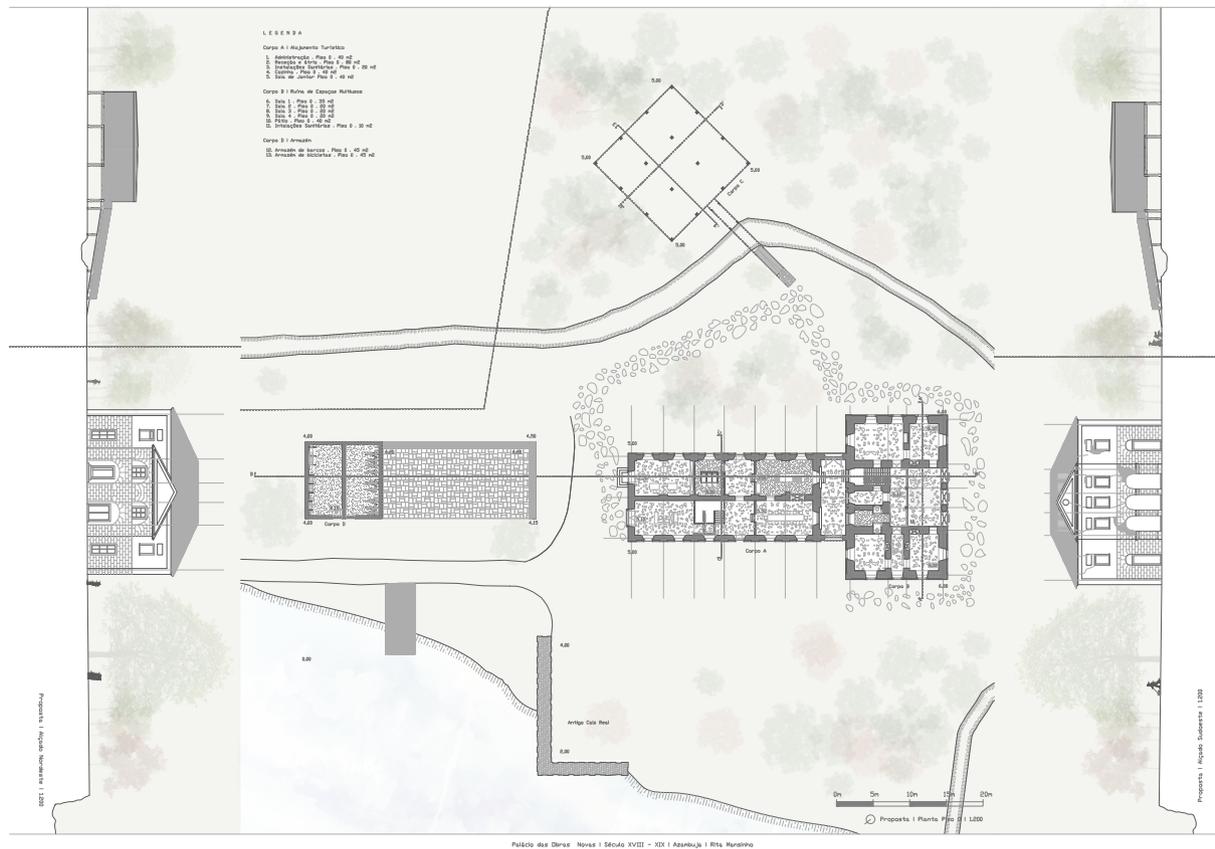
Planta Piso 0 e Alçados (fonte: autora).
